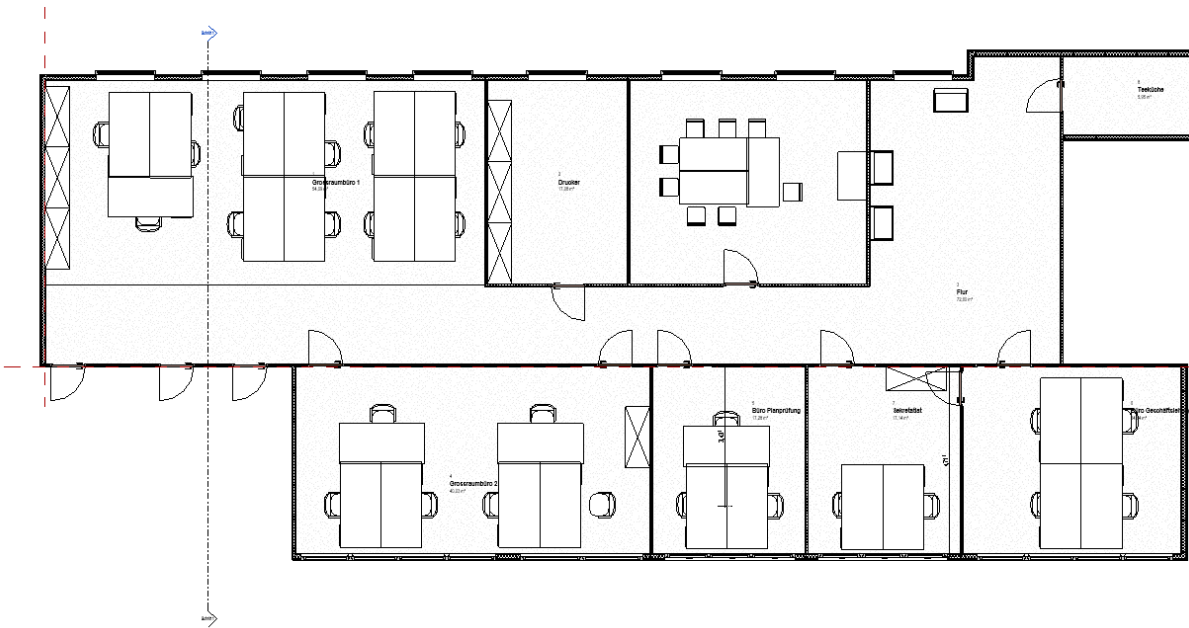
Versuchsgebäude 4: Grundriss nachmodelliert mit Autodesk Revit⁸¹
